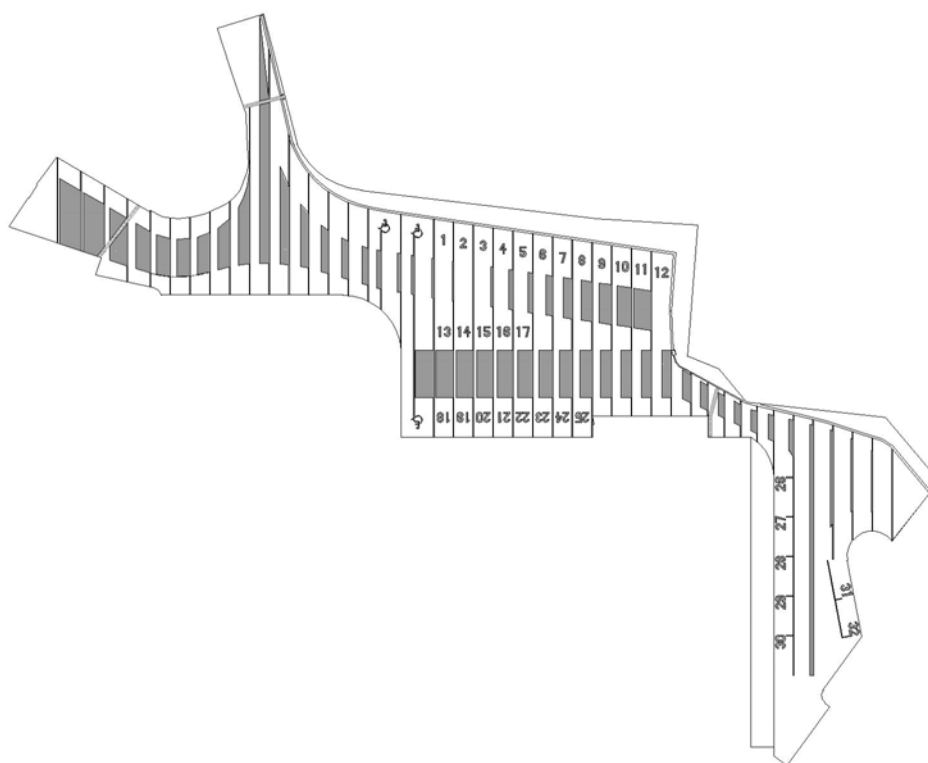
Schema della pavimentazione drenante e carrabile di progetto
